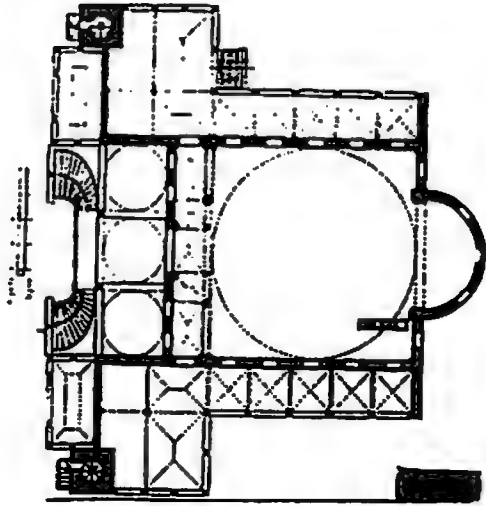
للمسقط الأقي لجامع السلطان سليم الأول في إستانبول .
